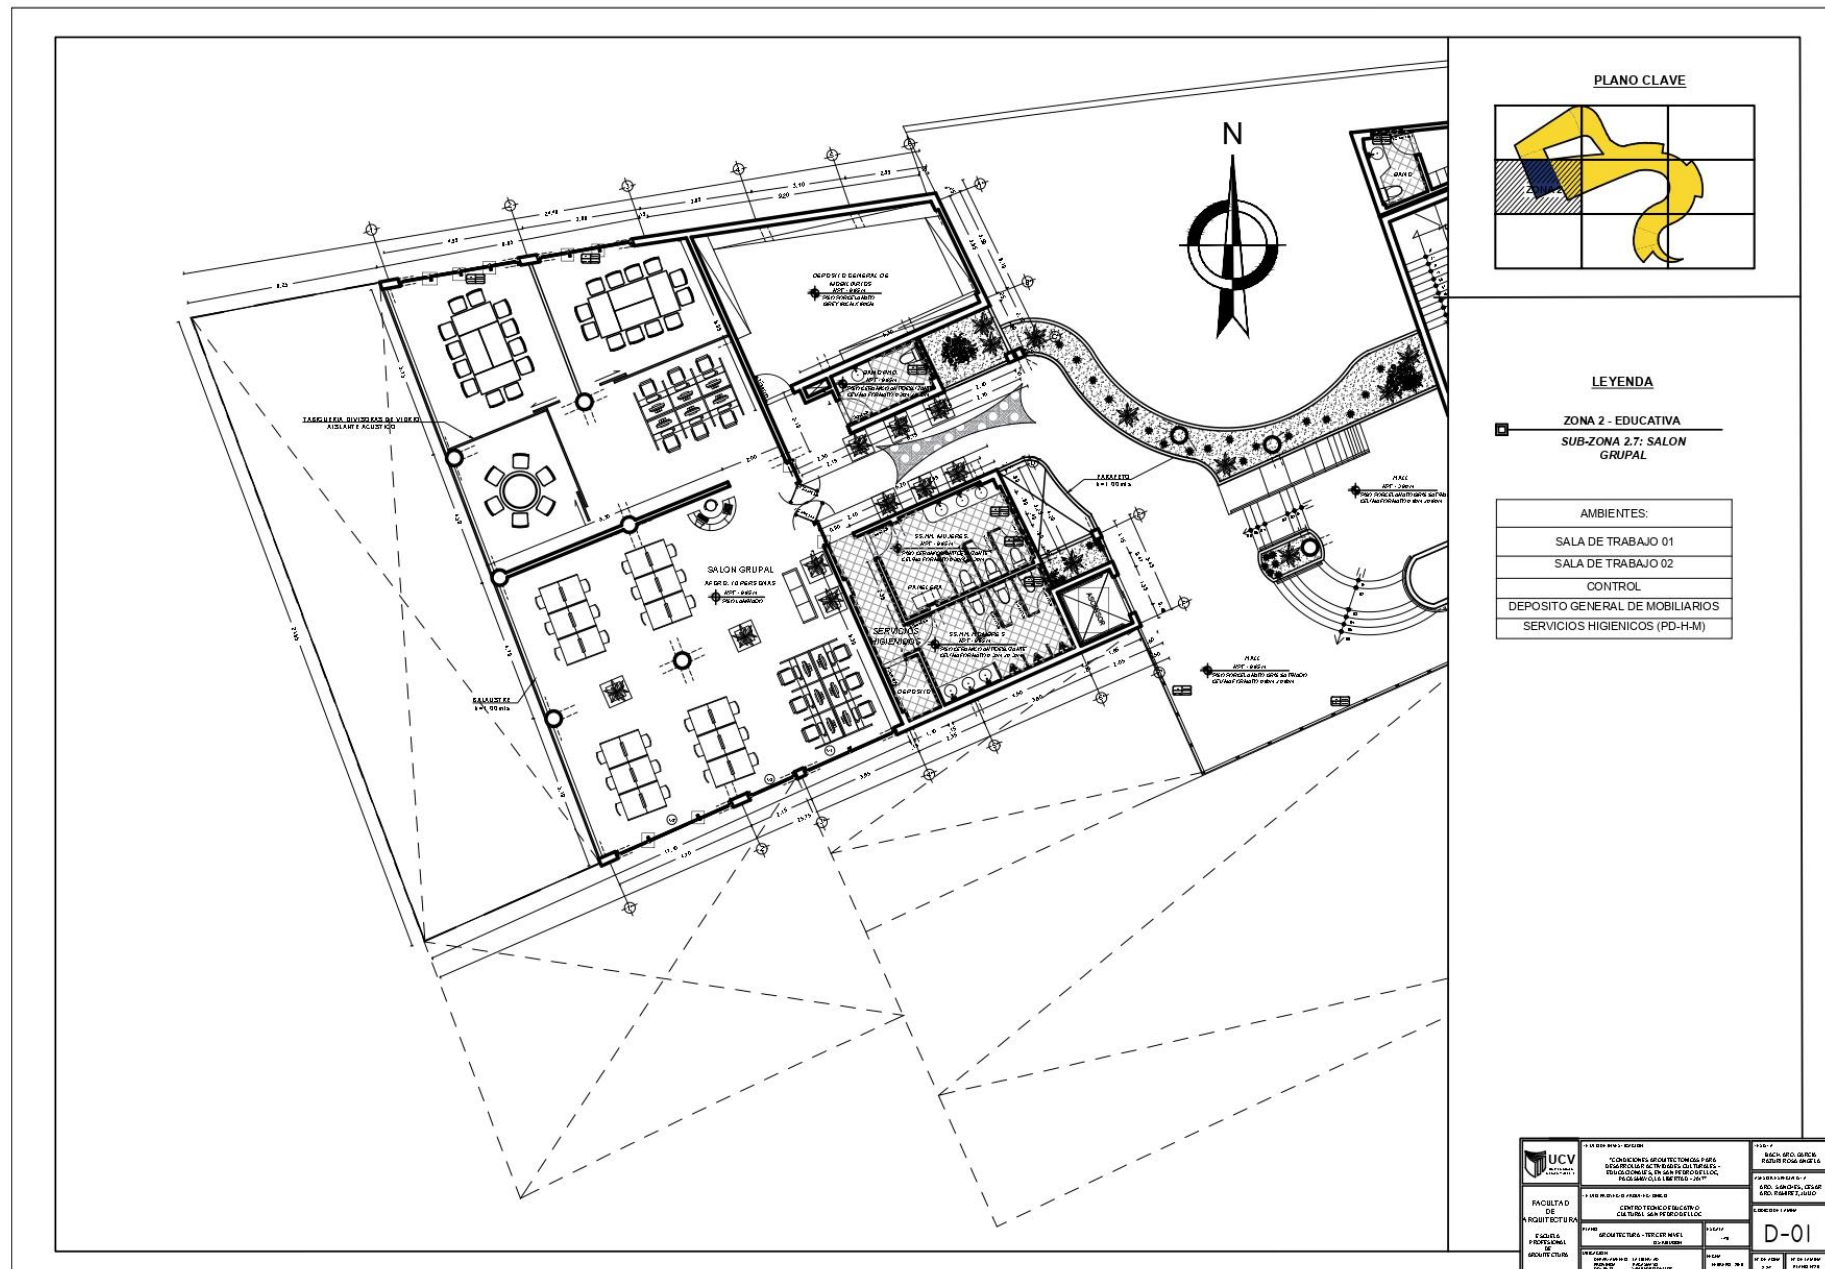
Plano de Desarrollo por Zonas - Plano N° 25 - Lamina N°: D - 01
